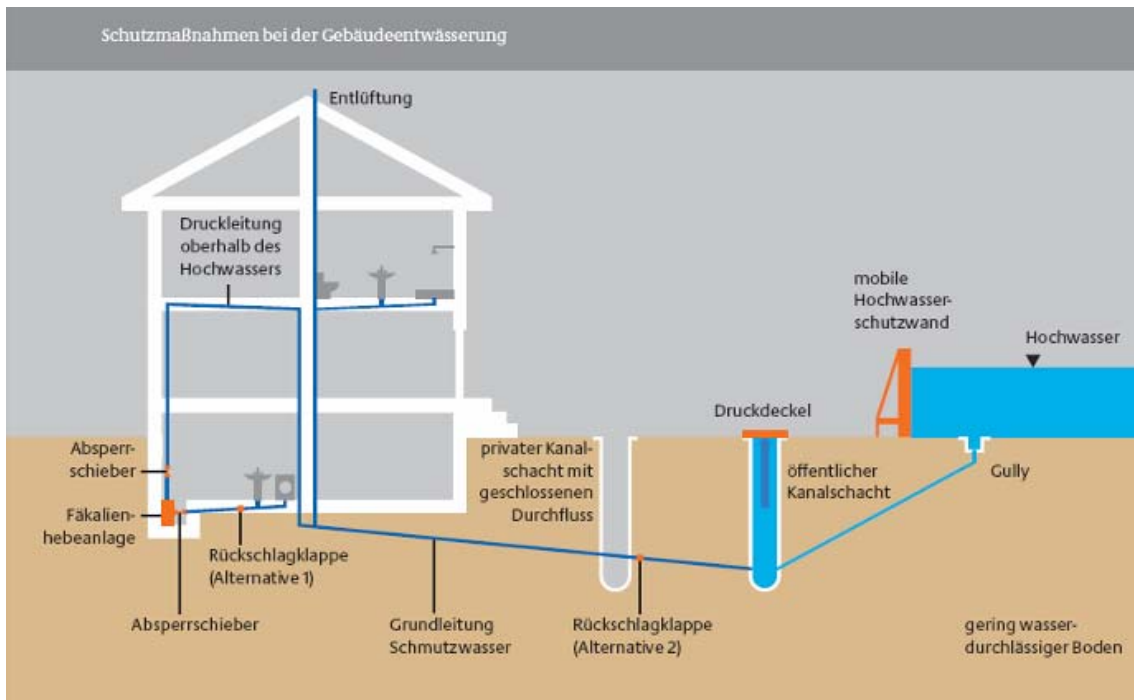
Schutz vor Kanalwasser (Rückstau) [44]
